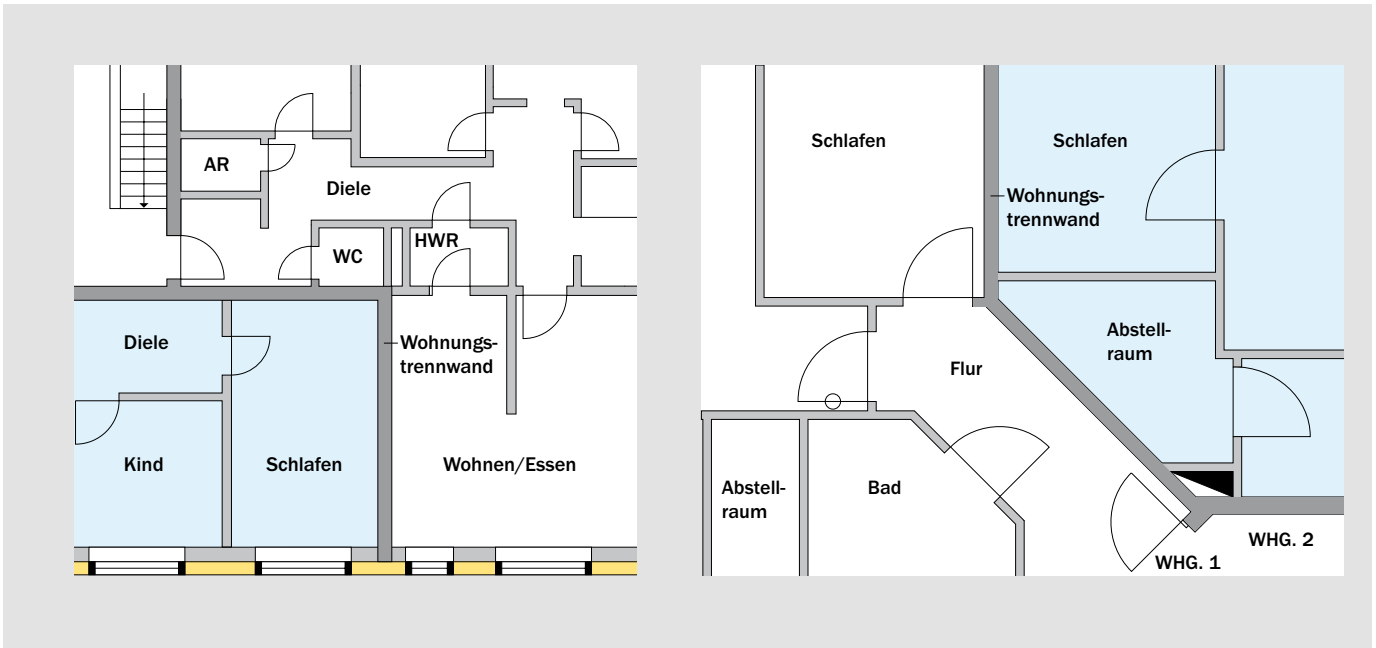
Grundriss-Situationen mit abgewinkelten Wohnungstrennwänden
